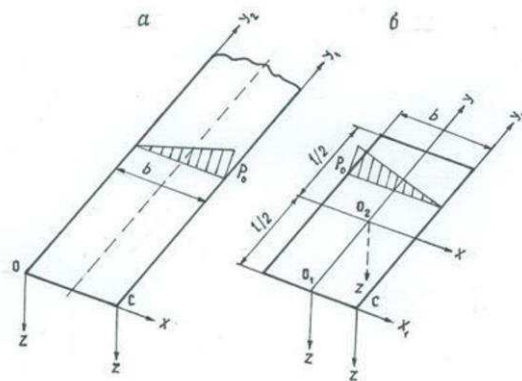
Схемы нагружения ленточного (полоса) и прямоугольного фундаментов:
